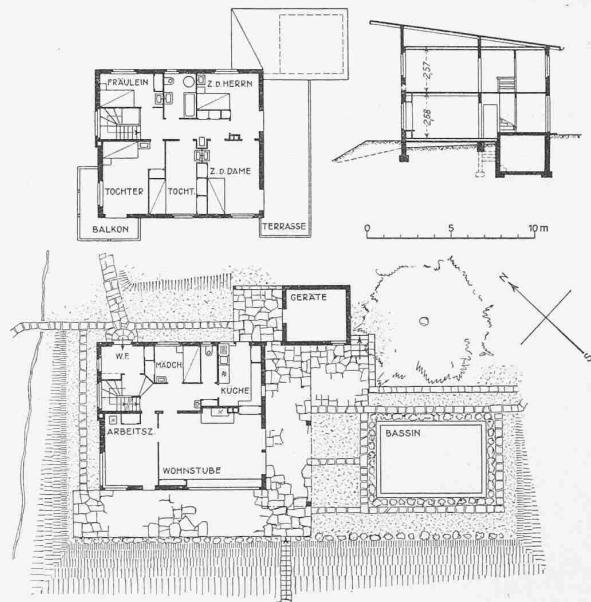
Grundrisse und Schnitt, Maßstab 1 : 400.
